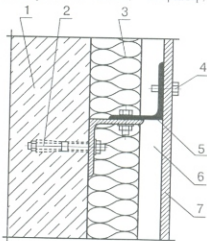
Схема анкерного крепления навесного фасада на несущей конструкции: 1 — основание (стена), 2 — анкер, 3 — теплоизоляция, 4 — крепежный материал, 5 — подконструкция (обрешетка), 6 — вентиляционный зазор, 7 — навесная панель
